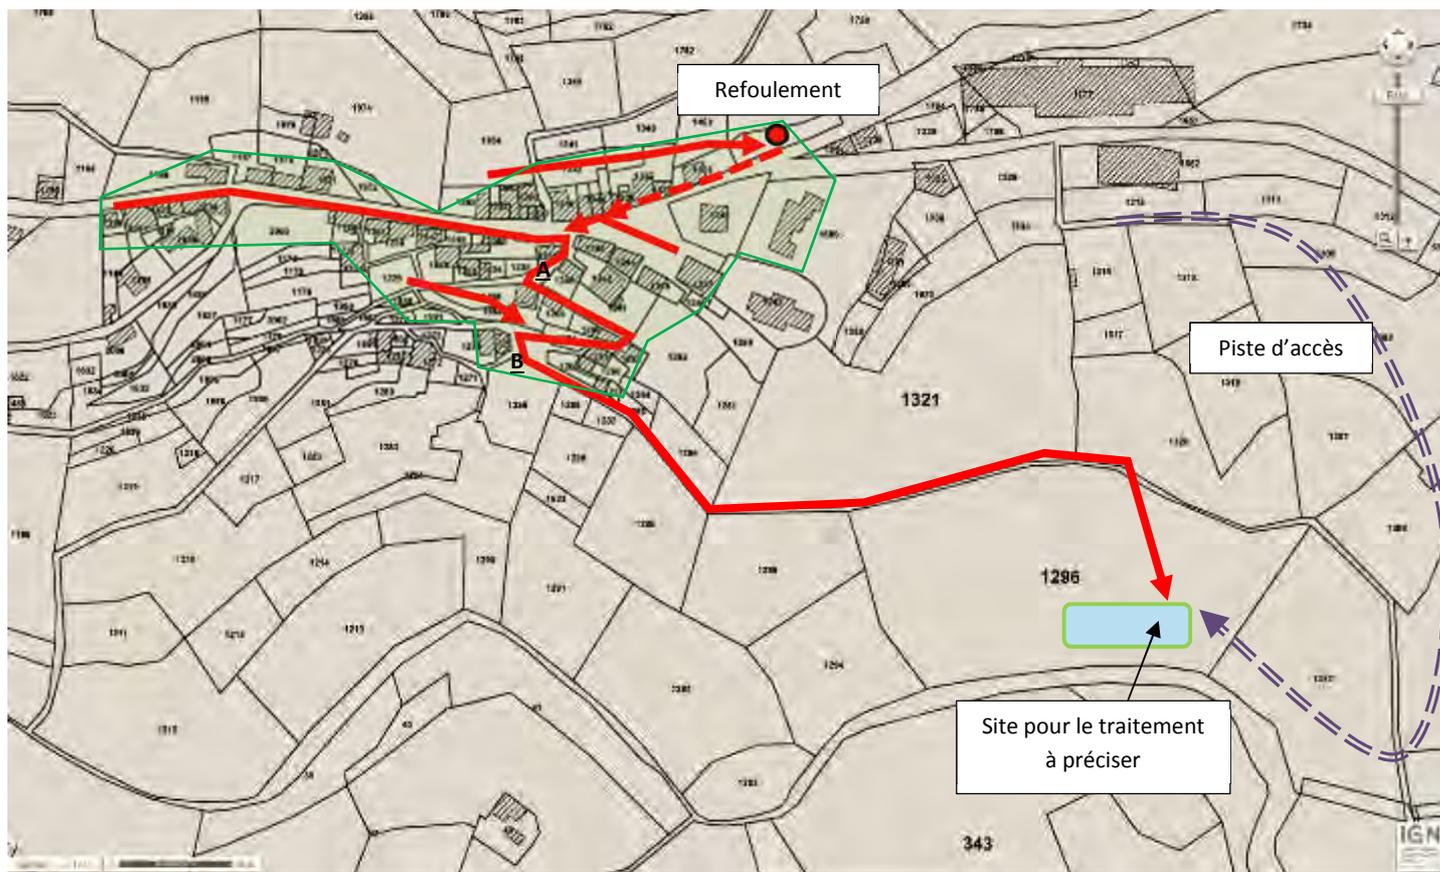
Plan de l'assainissement collectif sur le village de Saint Barthelemy Le Meil
